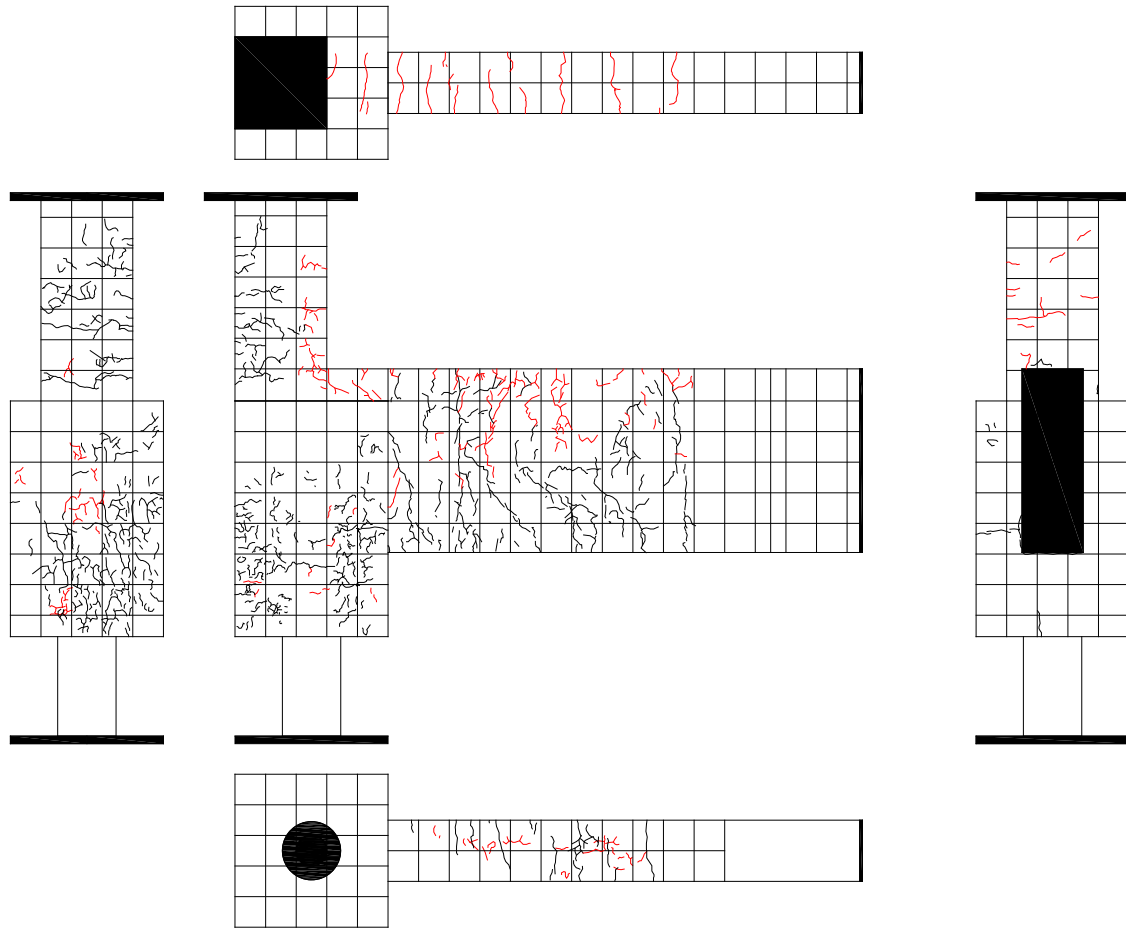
試験体 C-3 ひび割れ状況 (2Cycle)
